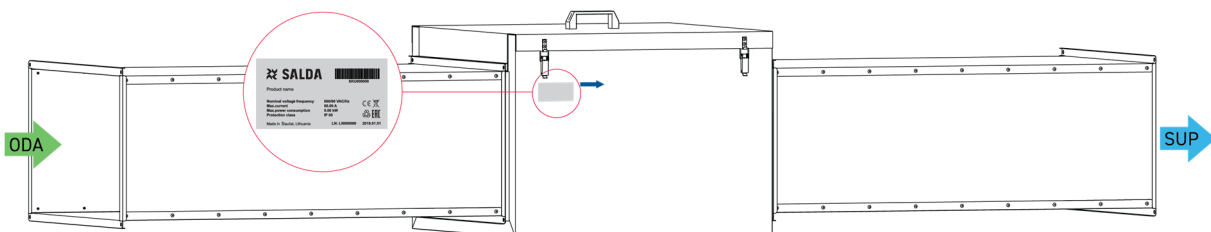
Umístění technického štítku AKU / AKU EKO a směr proudění vzduchu
